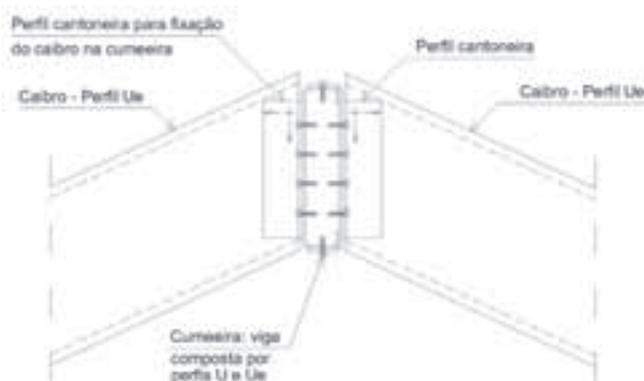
Cumeeira de telhado estruturado com caibros
